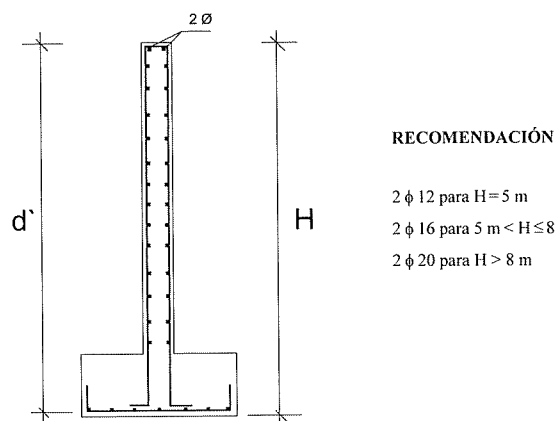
Recomendación para armaduras en la coronación del muro. (Tomada de *Cálculo de Estructuras de Cimentación*, 4ª edición - J. Calavera)
